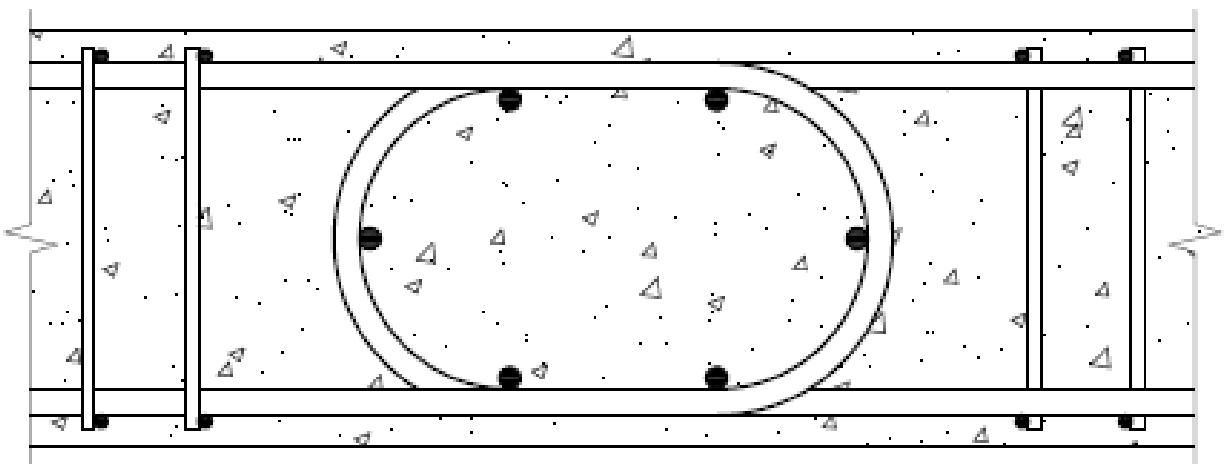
Петлевой стык арматуры с продольным армированием ядра
